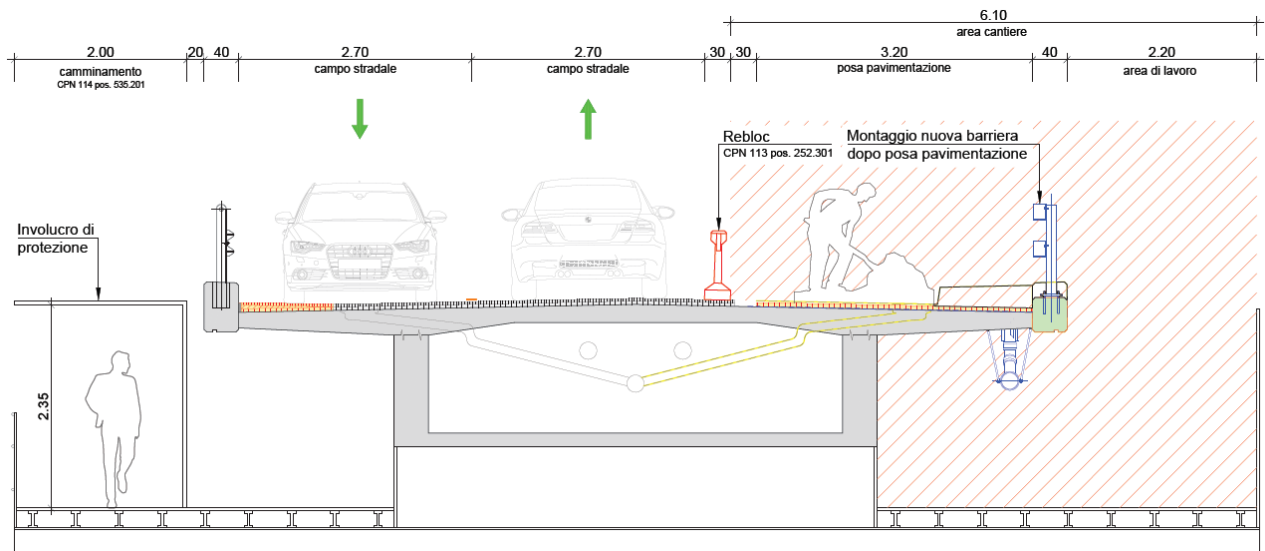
Sezione tipo con ponteggi durante le fasi di lavoro
